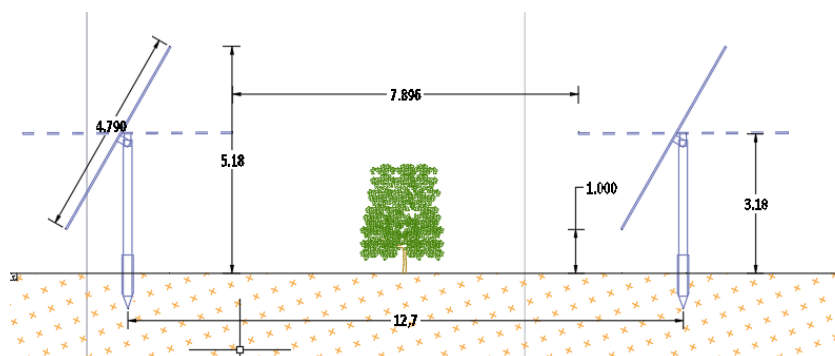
Sezione lotto d'impianto con tracker 2V30
